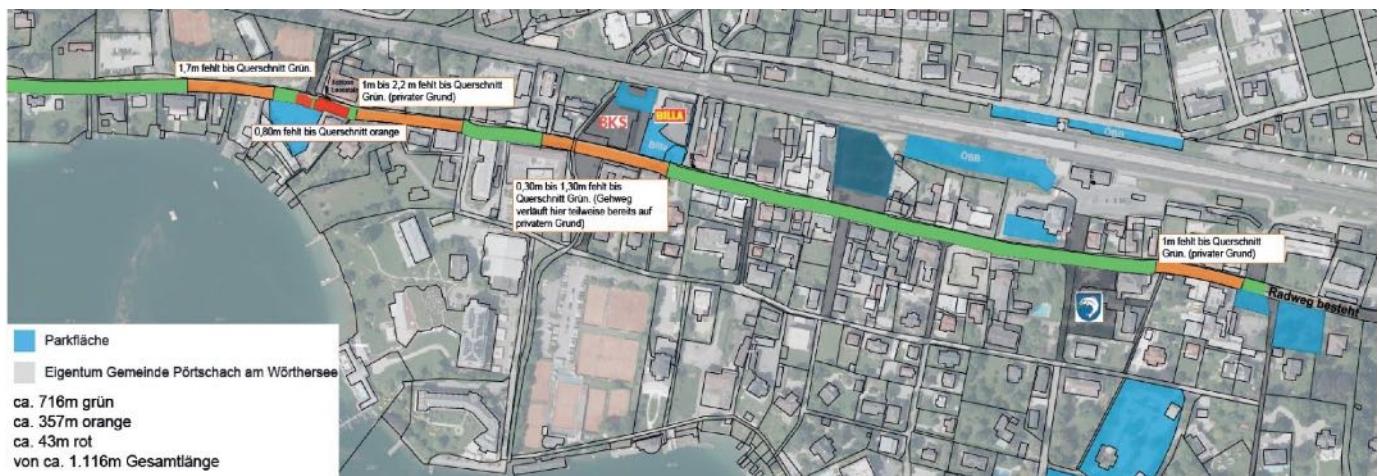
Übersichtsplan Planfall 4, 5a und 5b kombiniert, [Quelle: PLANUM]
